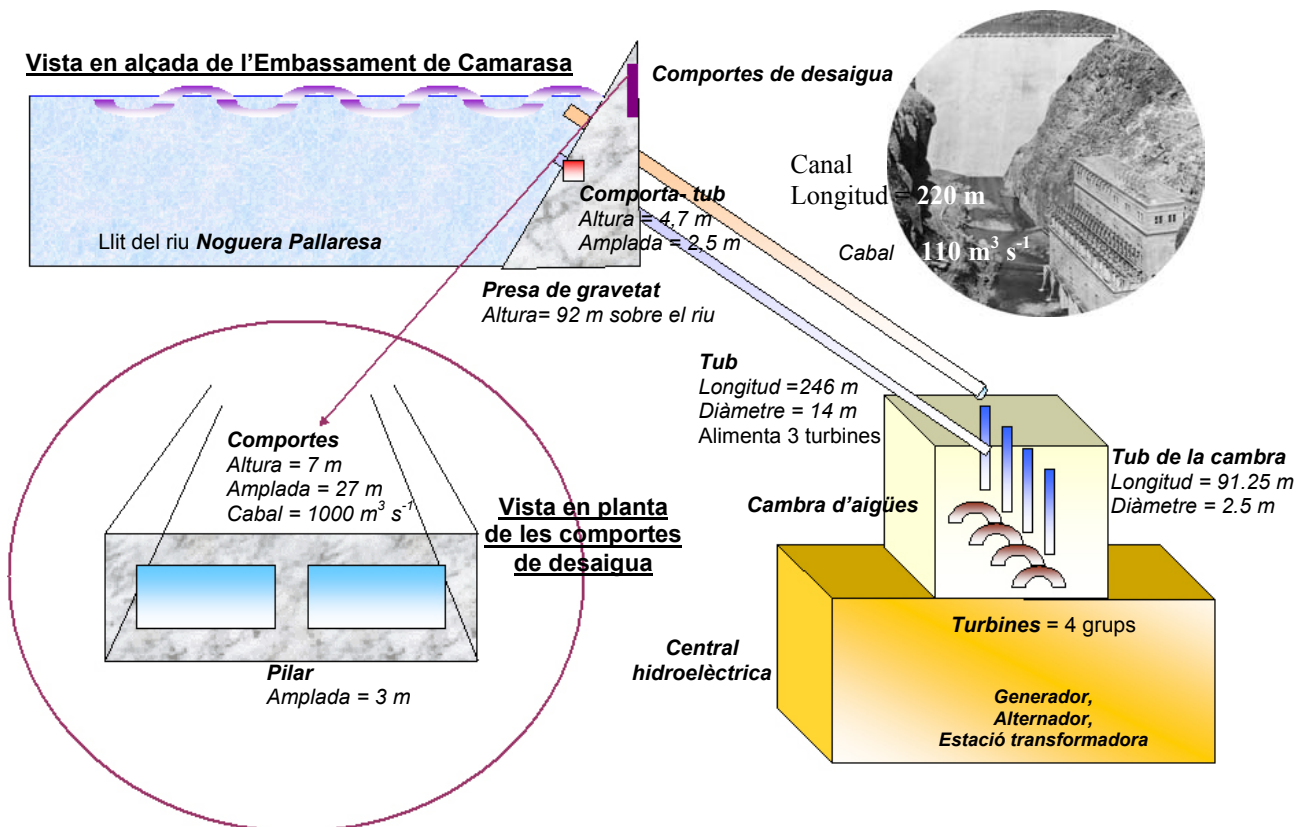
Vista en alçada i en planta de la central de Camarasa.
